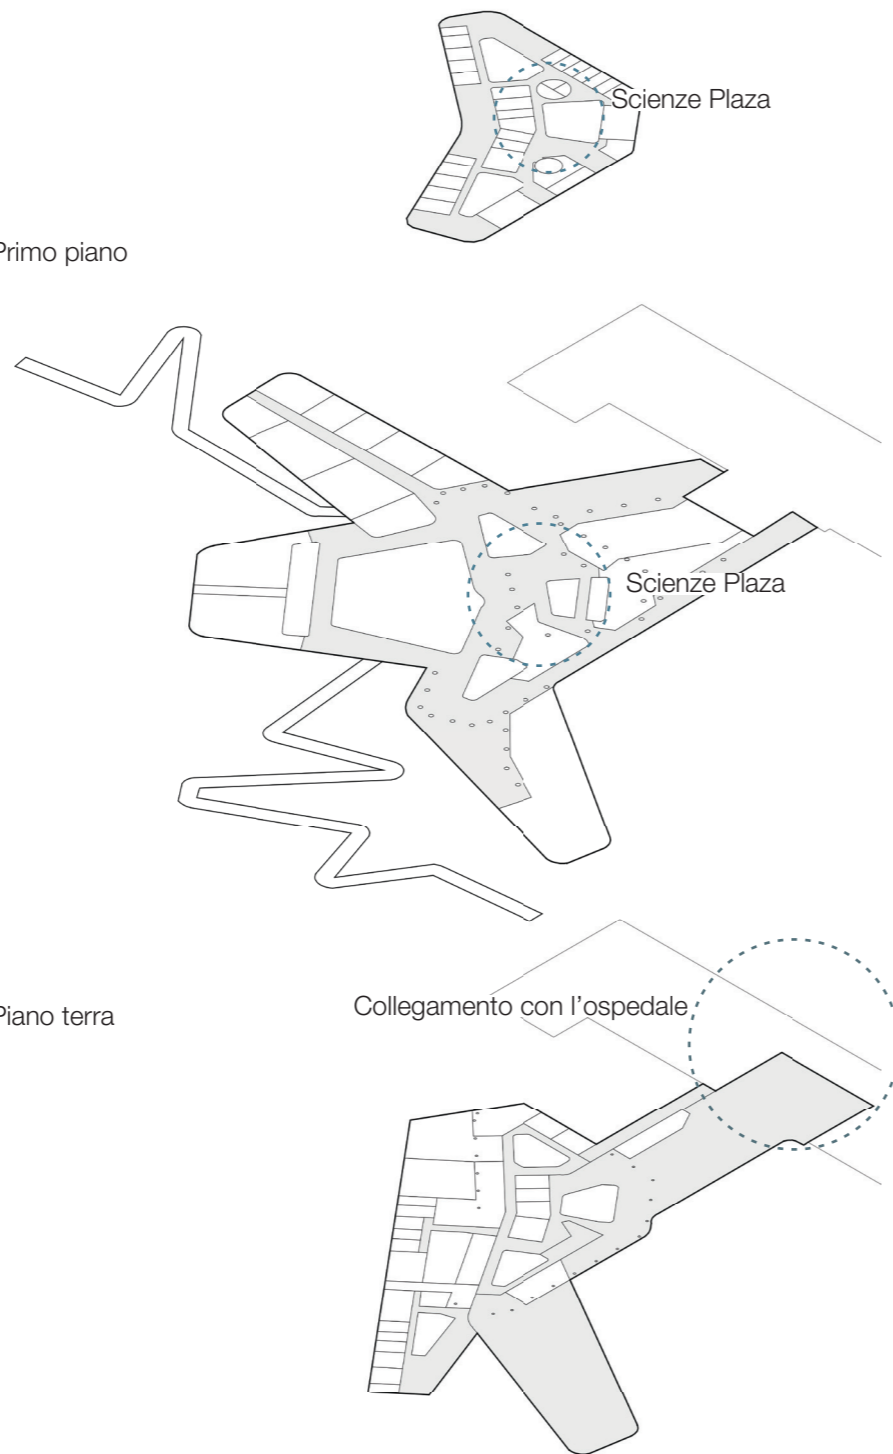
Planimetrie dei vari piani della torre. Elaborato ZA, 2022.
